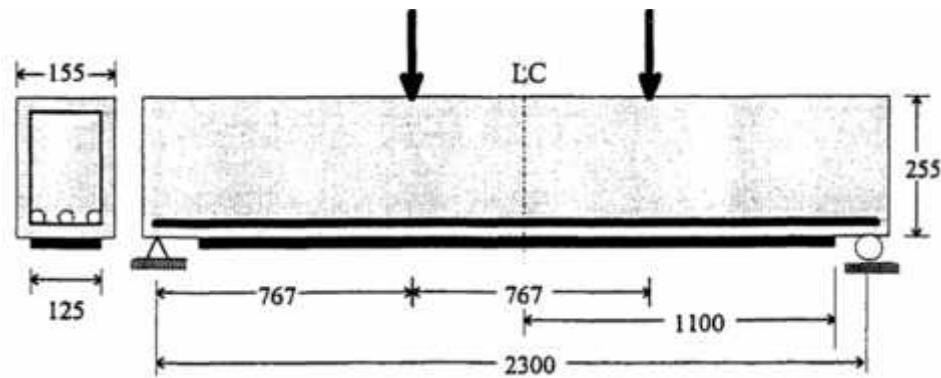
poutre armé renforcé à l'aide d'une plaque d'acier [9]
